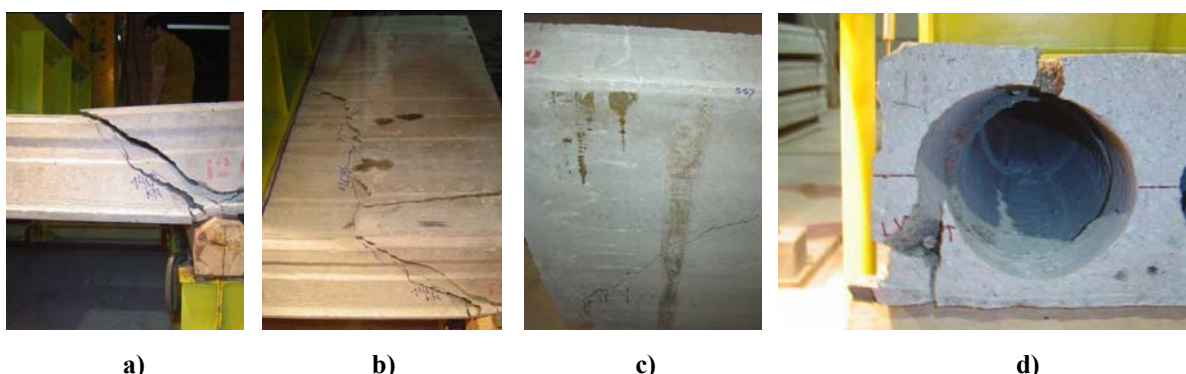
Configuração da fissuração da laje L12-SC-AP-7_C: a) Fissuração da lateral da laje (lado esquerdo); b) Fissuração da parte superior da laje; c) Fissuração da parte inferior da laje; d) Rompimento da parte superior da laje, junto ao alvéolo de extremidade.
